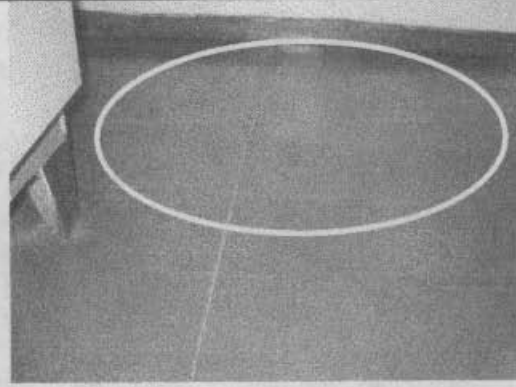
Asentamiento del Muro divisorio y común del la edificación con el predio siguiente al Occidente.
